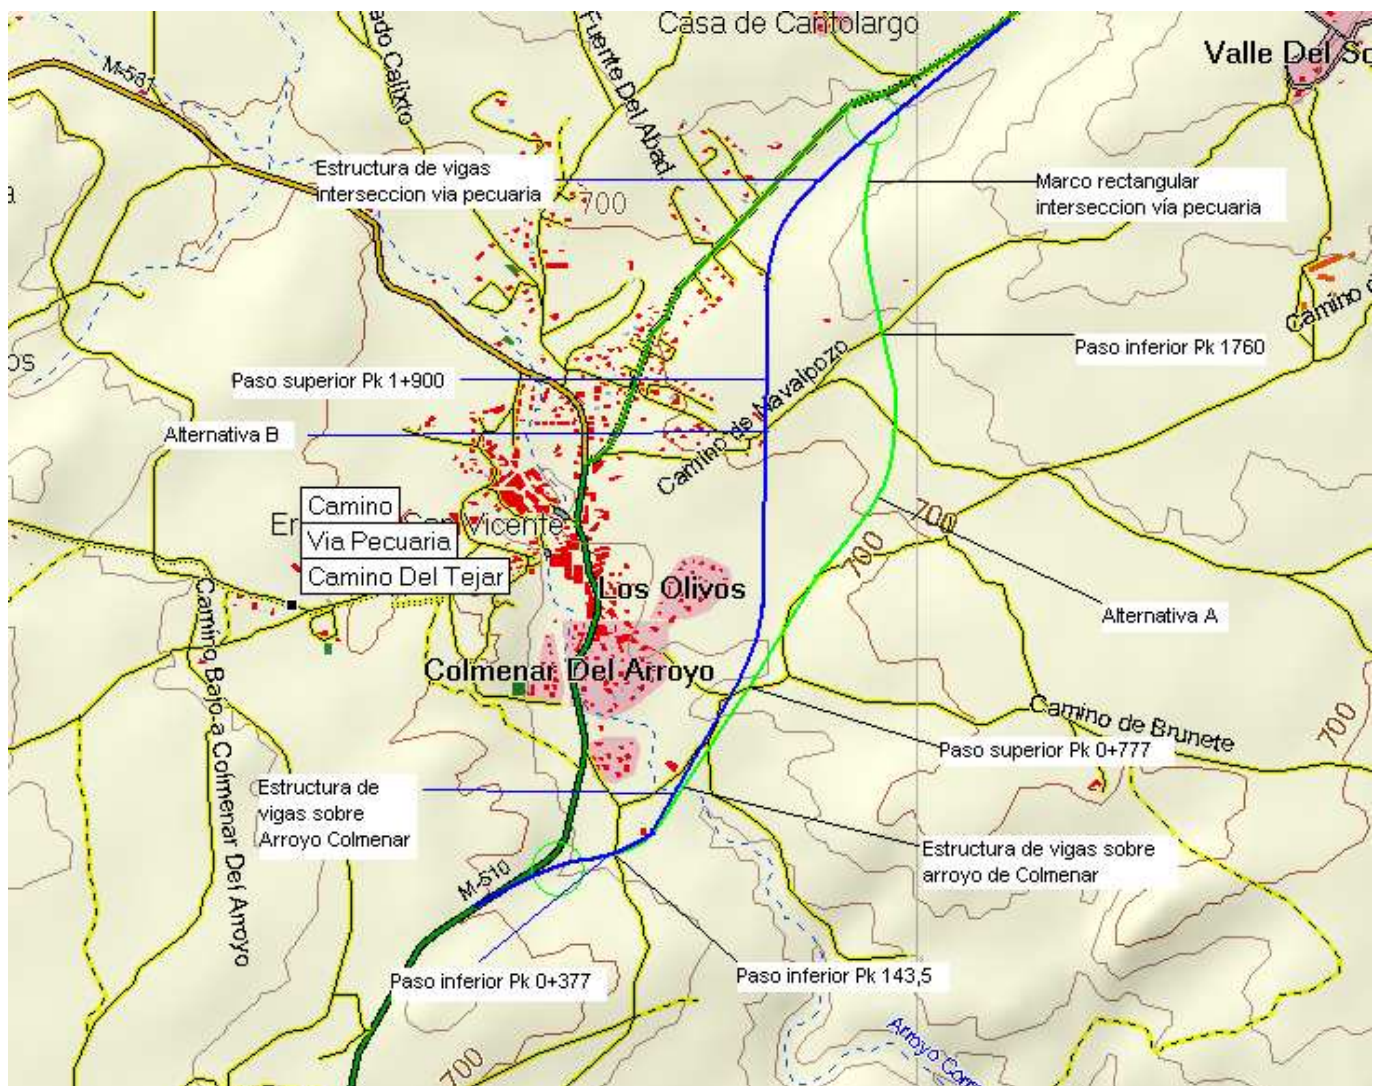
Trayectorias alternativas proyecto y estructuras necesarias para salvar intersecciones. (1:500)
